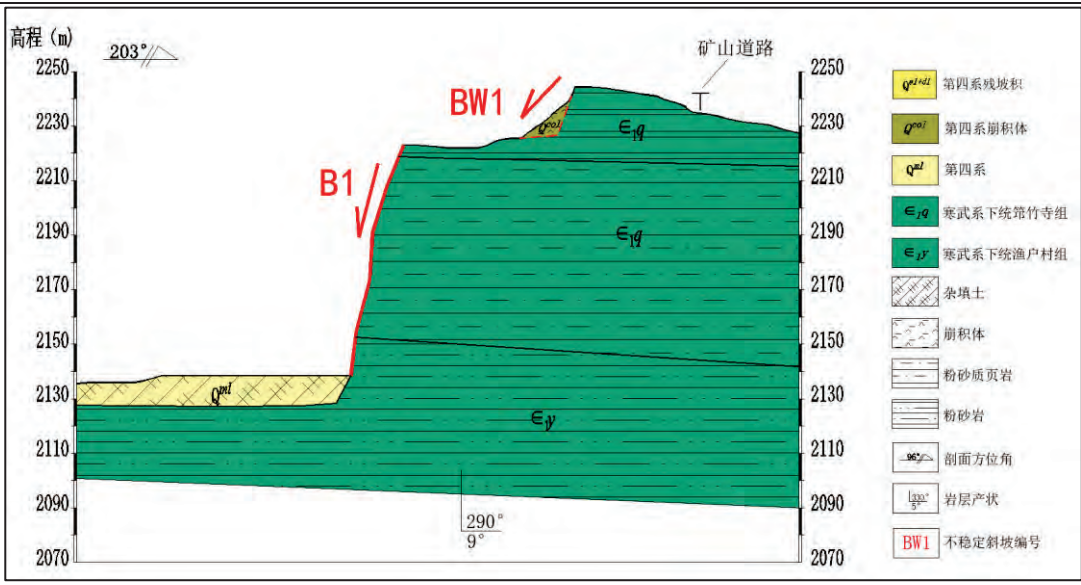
BW₁ 不稳定边坡地质剖面图
